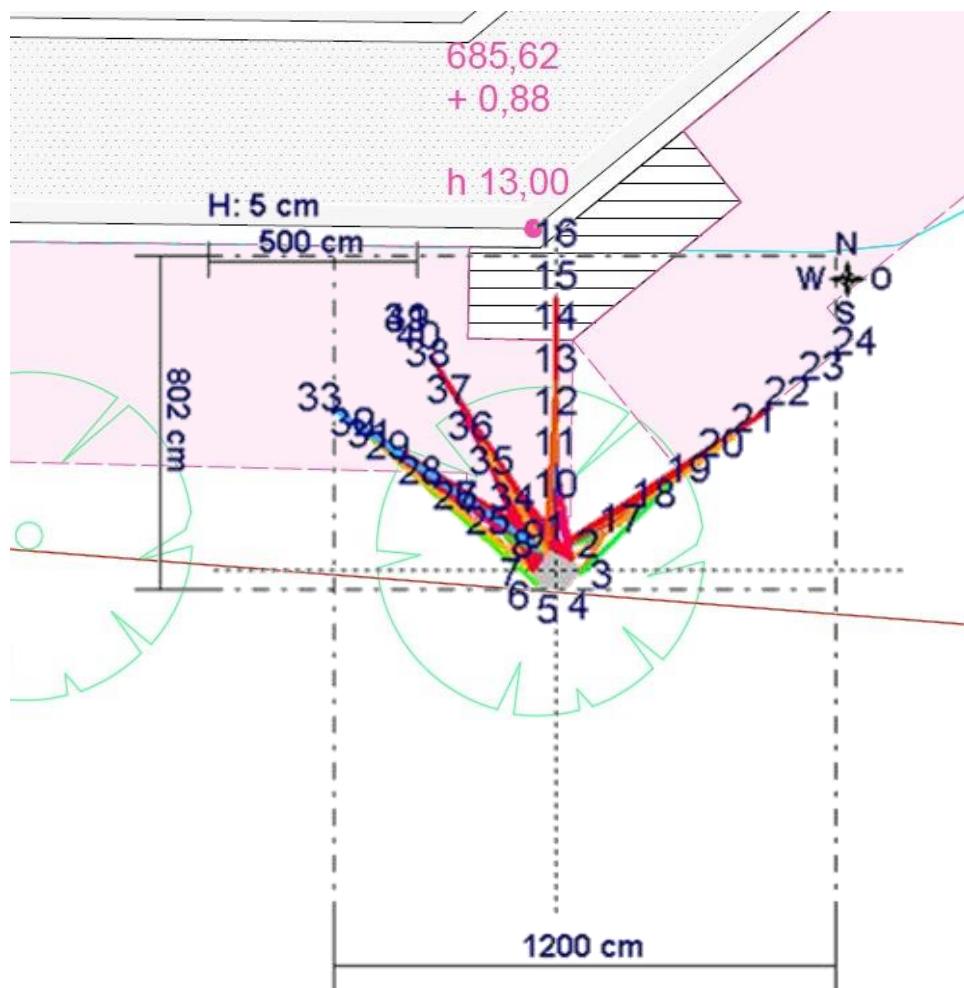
Baum Esche 5 - Ausschnitt aus dem Lageplan (Herr Christian Mandl und Dipl.-Ing. (FH) Architekt Werner Marz – Hochbau – Stadt Kaufbeuren) mit der gutachtengegenständlichen Esche 5 (1:200) und dem überlagerten Wurzeldiagramm.
